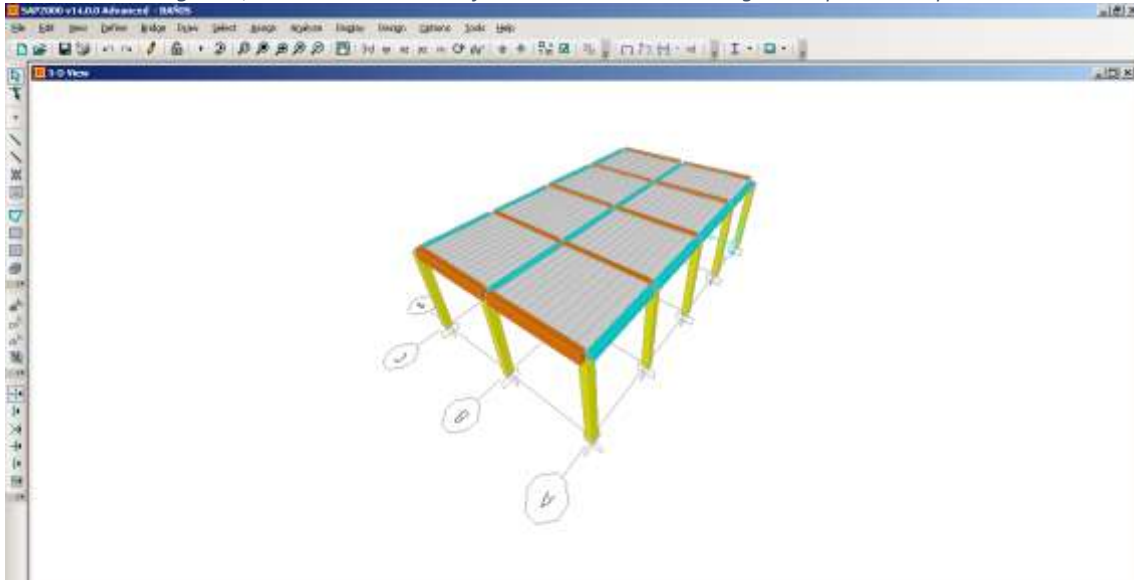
, Modelamiento de la infraestructura del Polideportivo, Estructura metálica
